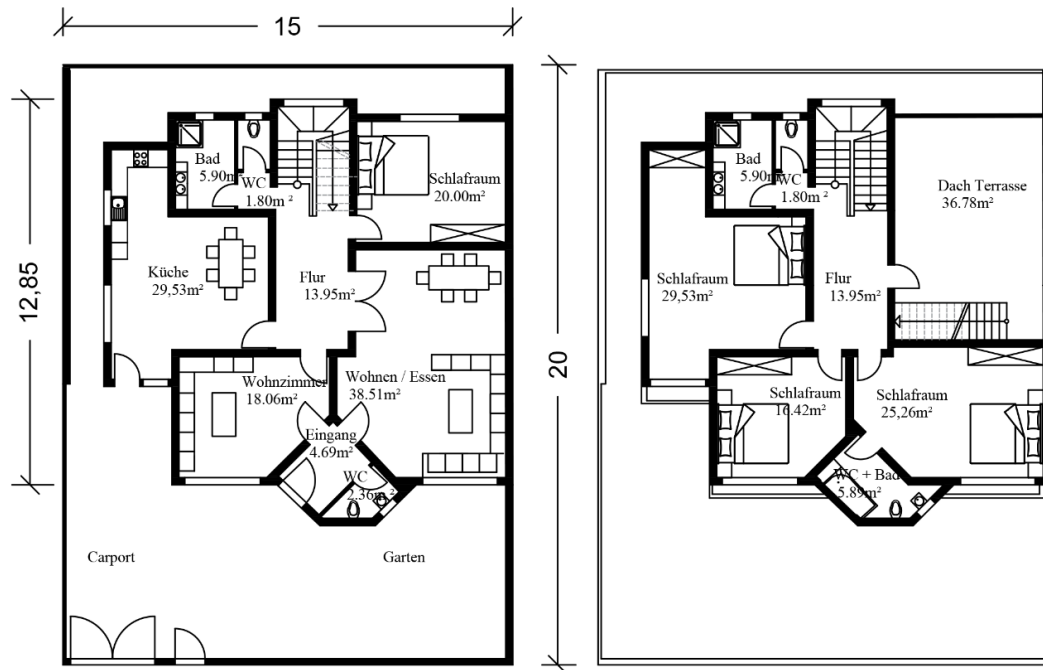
Villa Grundriss Typ A 300 m¹⁸⁸
